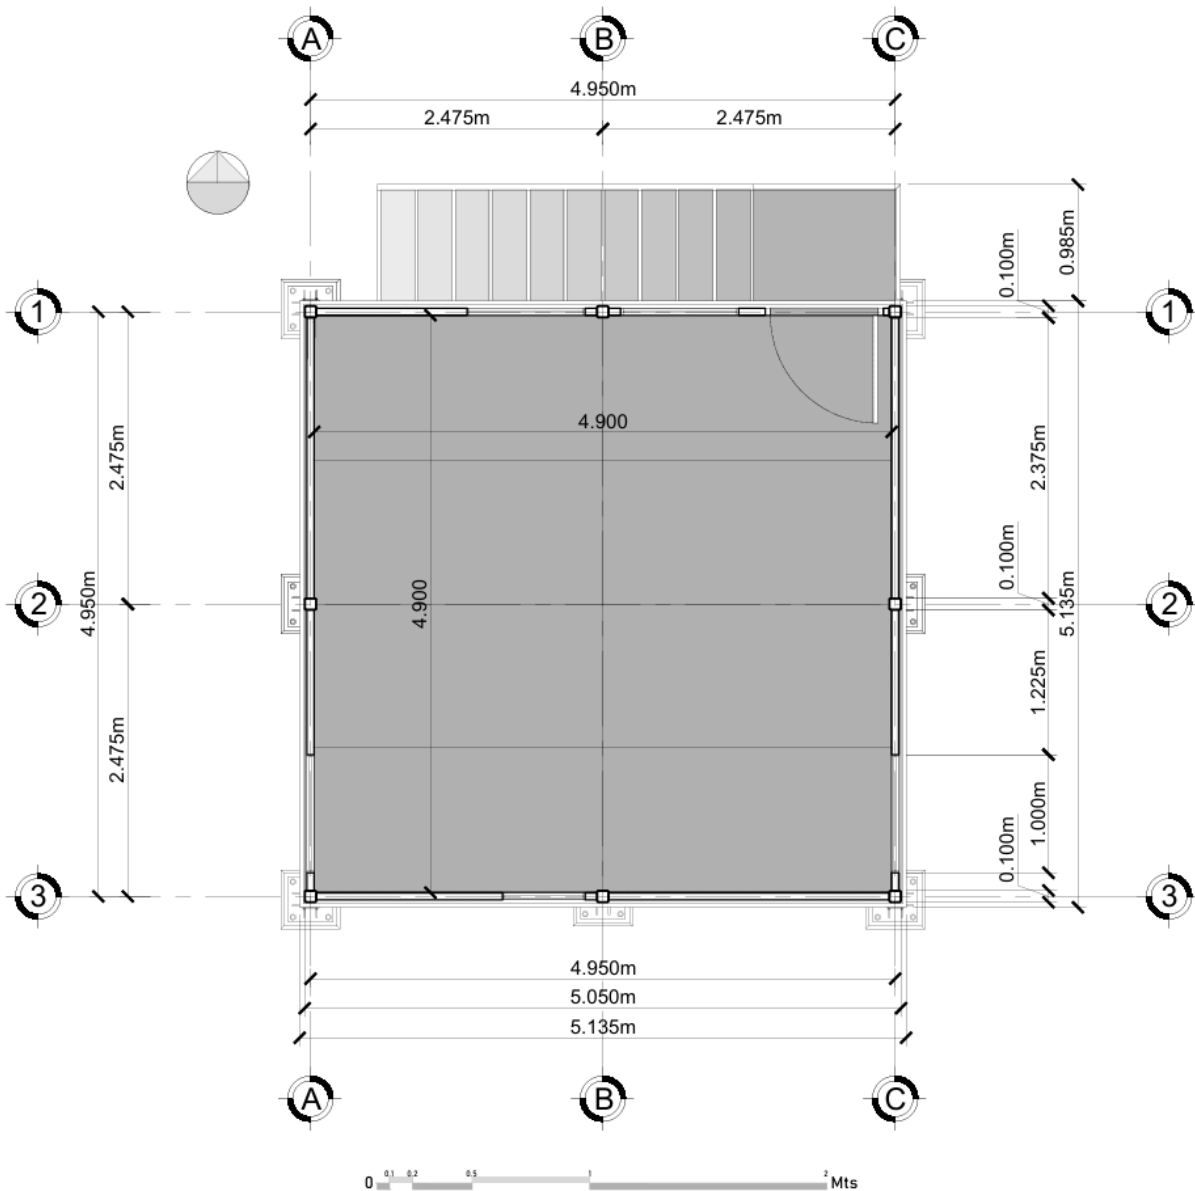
Módulo Base (Planta Arquitectónica). Fuente: Elaboración propia
